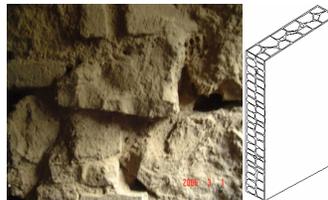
Figure8. Le mode constructif (Source: Auteur)
